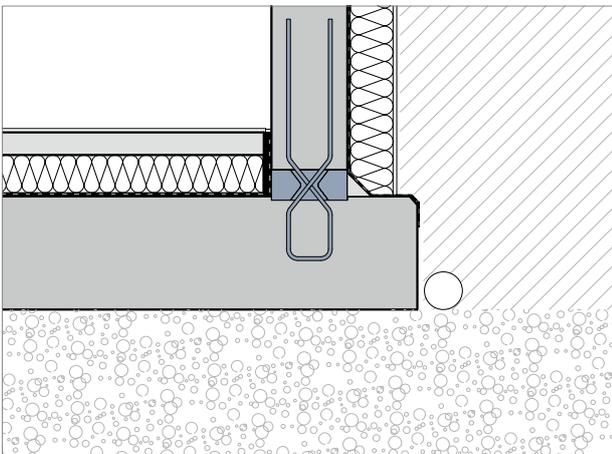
Schöck Sconnex® type W mur extérieur sur radier
